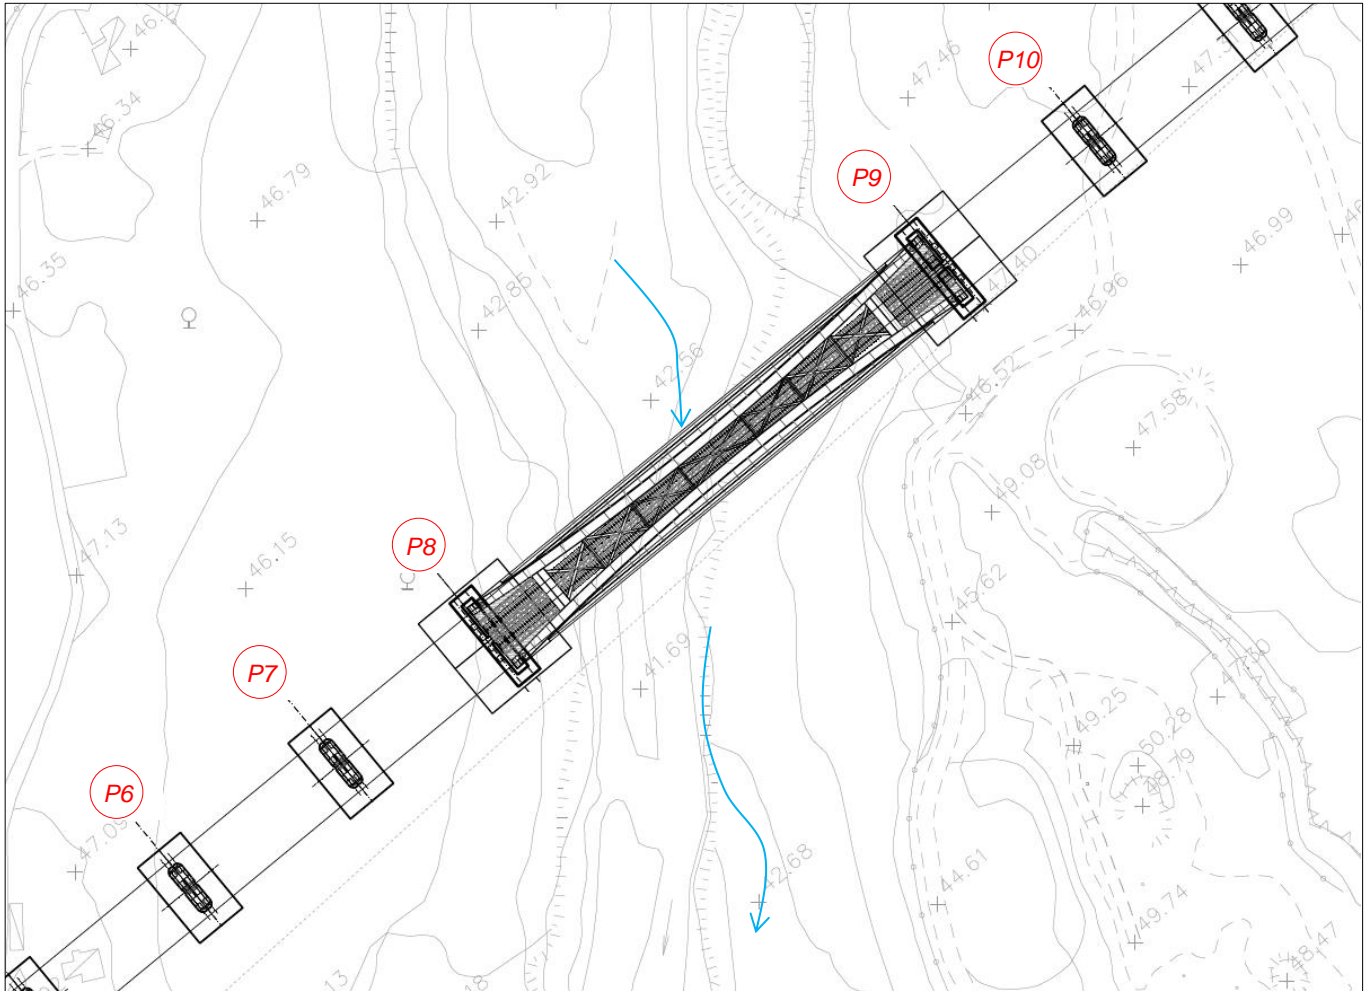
Stralcio planimetrico del viadotto in progetto sul Fiume Alcantara.
